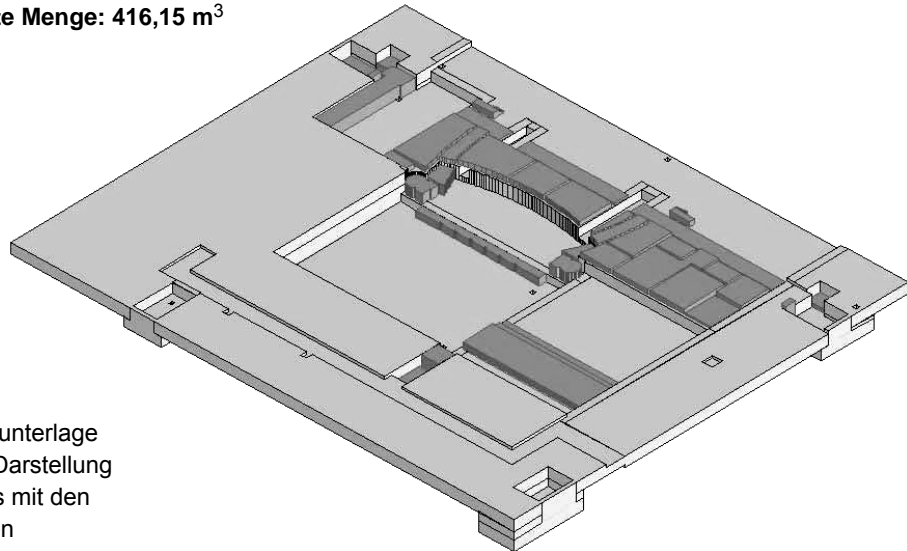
mitgelieferte Planunterlage des Architekten, Darstellung des Fundamentes mit den Aufbetonbereichen
